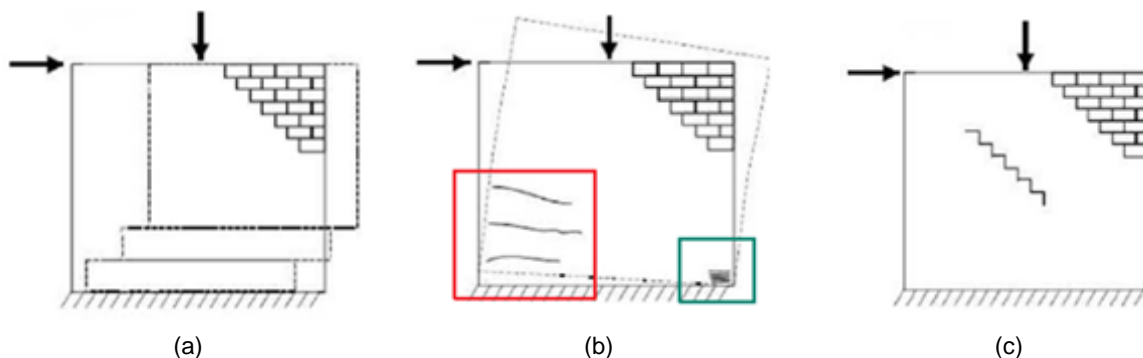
Formas de rotura das paredes de alvenaria submetidas a ações no plano [15]: (a) Rotura por deslizamento. (b) Rotura por flexão. (c) Rotura por corte.
